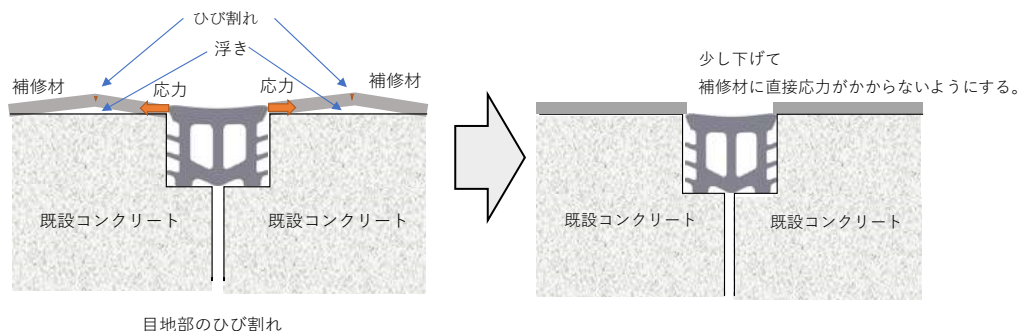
目地に起因したひび割れの抑制方法（例）
